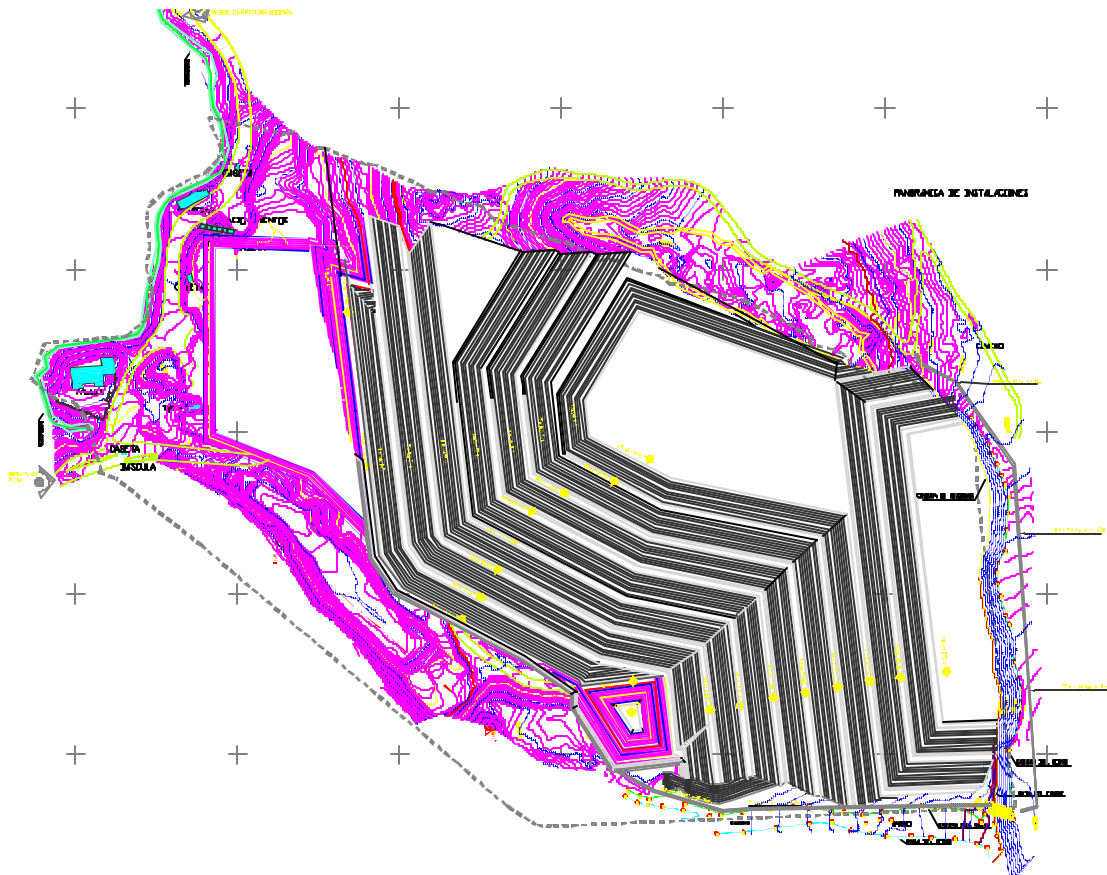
Disposición de las celdas del plan (material proporcionado por la empresa)
